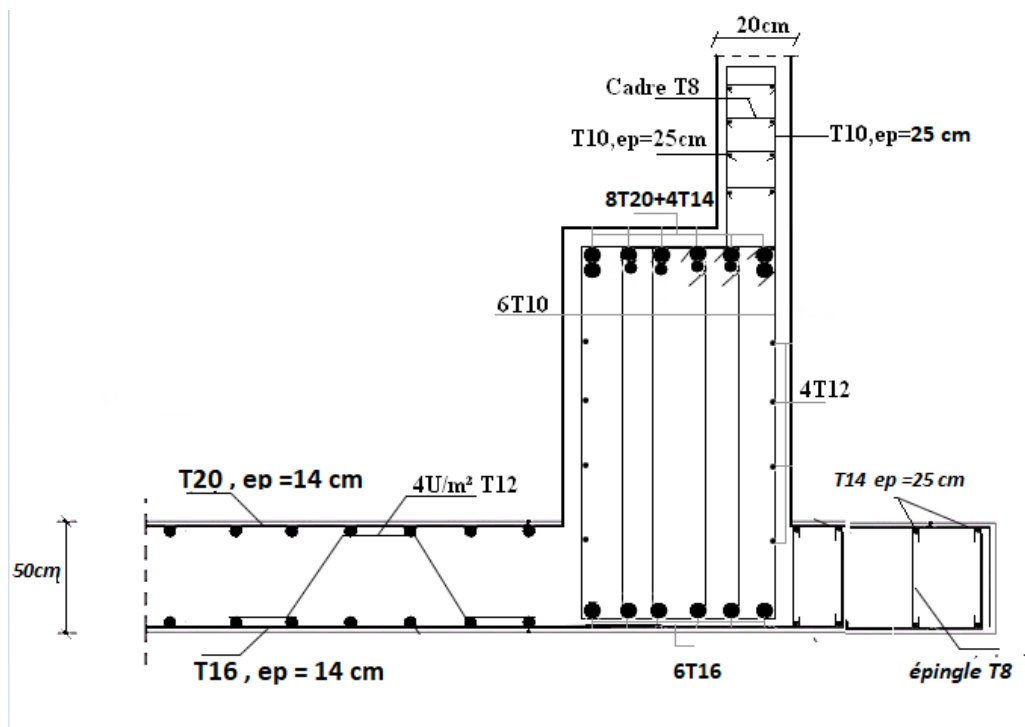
Ferrailage du radier, nervure, voile périphérique et débord sur une coupe en travée.
